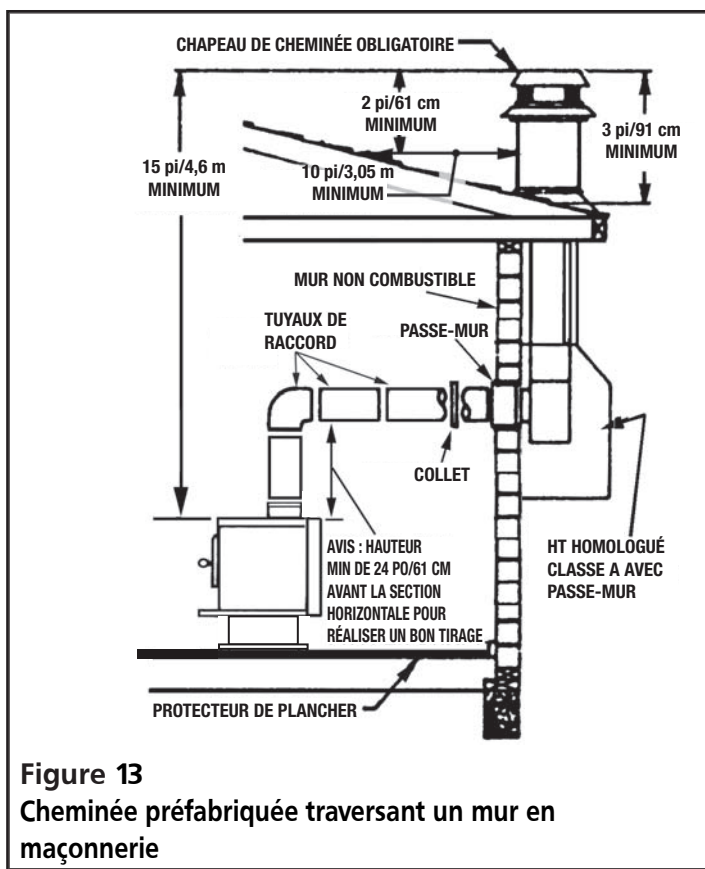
Cheminée préfabriquée traversant un mur en maçonnerie
